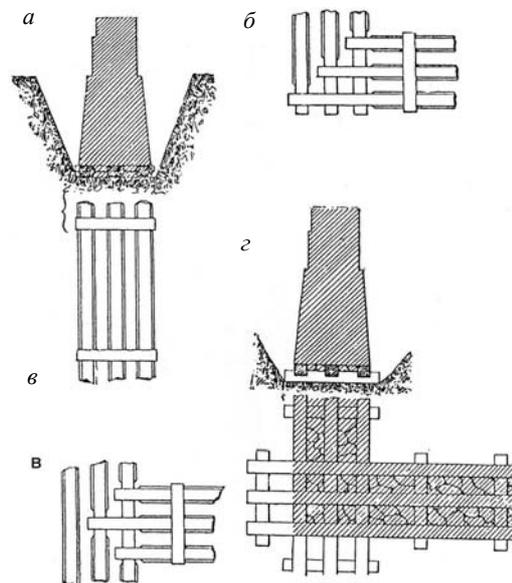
Примеры устройства ленточных фундаментов [2]: а – на лежнях, б – укладка лежней на углу здания; в – укладка лежней для внутренней стены; г – на деревянном ростверке
